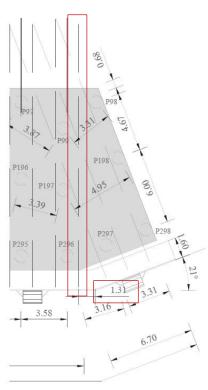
Posizione tirante numero 195 -1114.STR.07.03 - Planimetria di intervento\_Rev2
